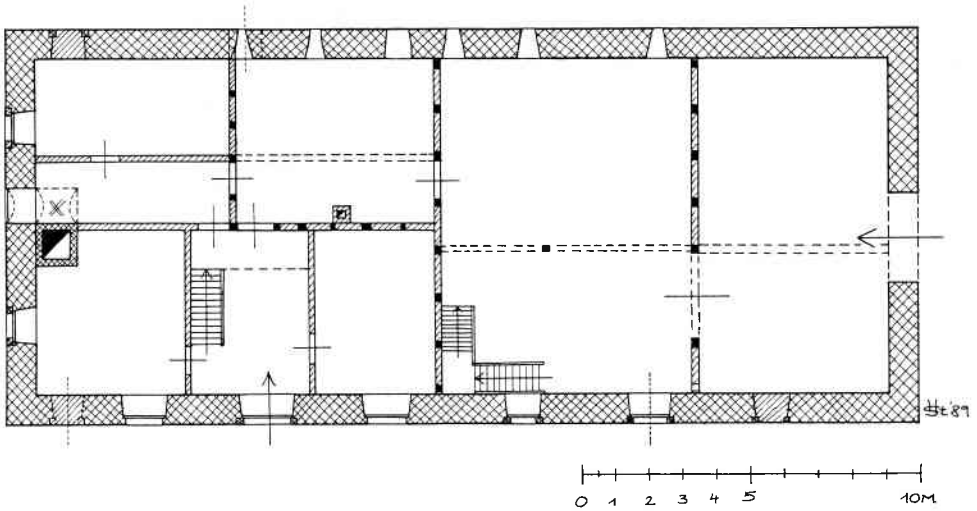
„Steinhaus“; Grundriß, Zustand vor dem Umbau 1987.
